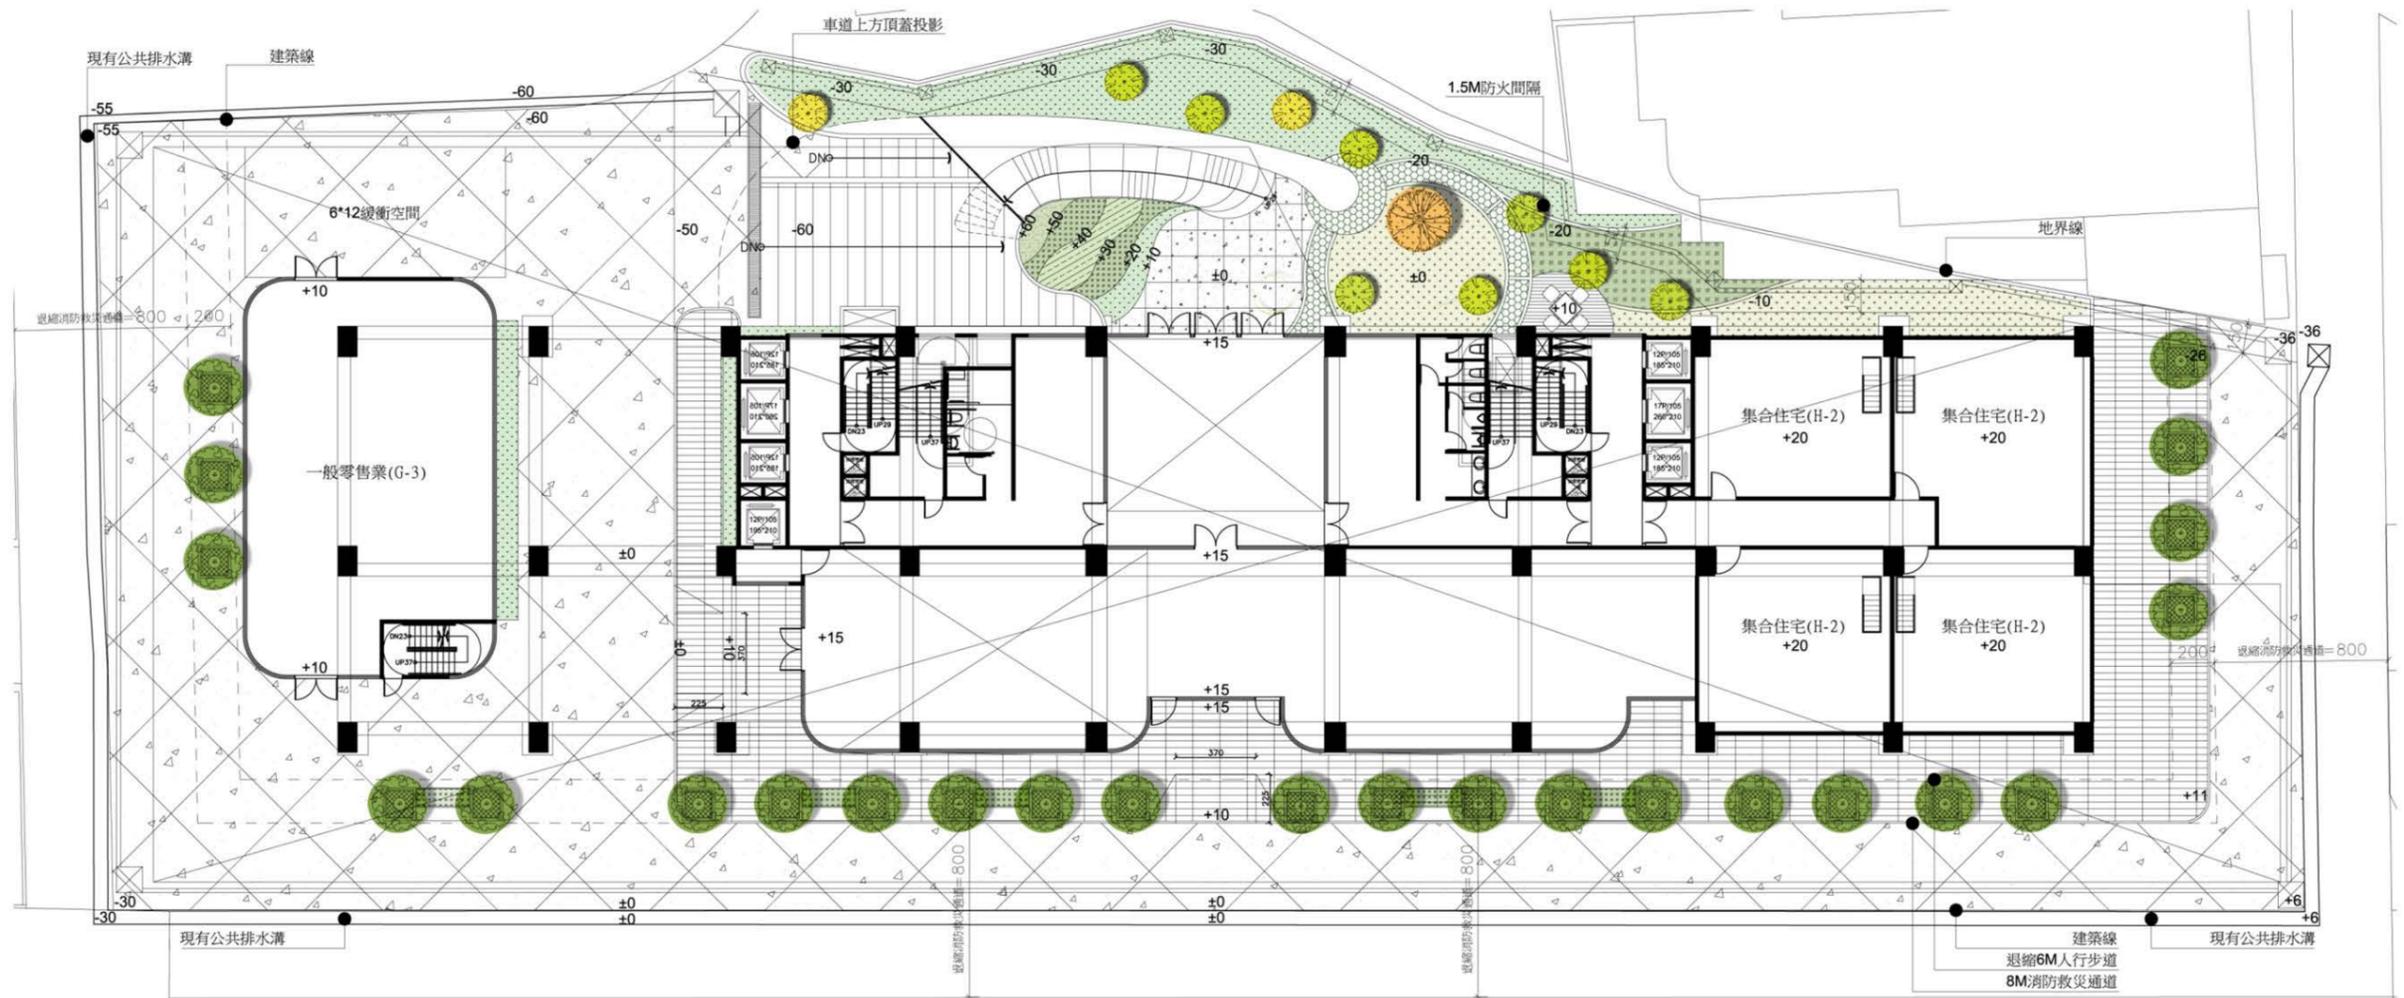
建築基地景觀植栽計畫示意圖(喬木)
